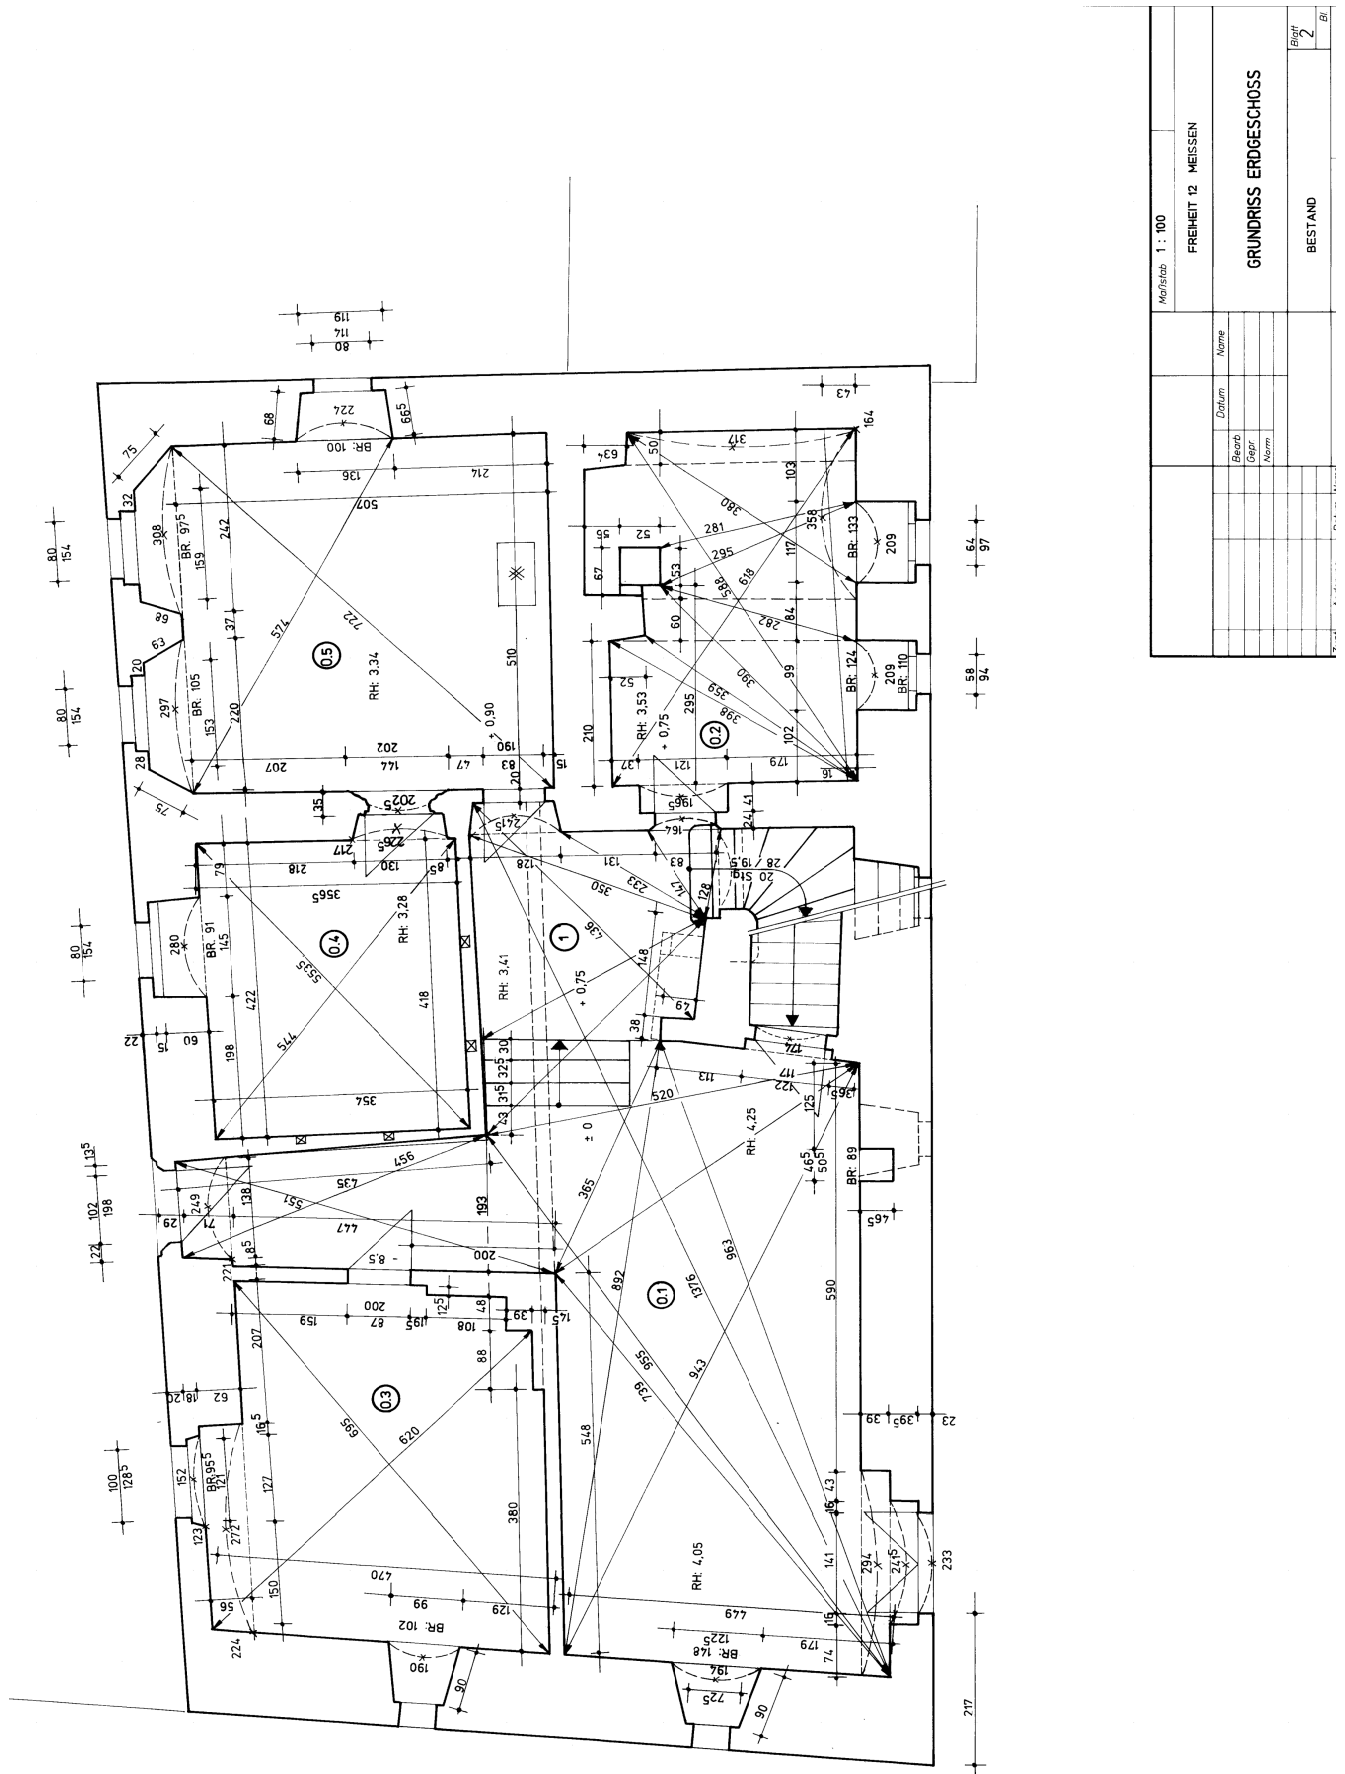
Freiheit 12, Grundriss Erdgeschoss Bestand
